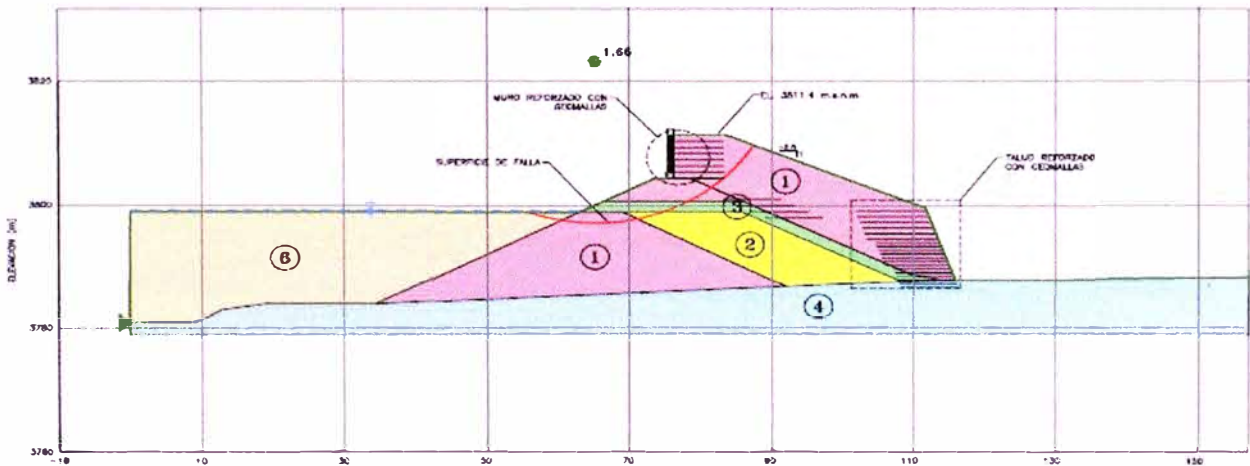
Muro de talud Reforzado - Análisis Estático - Sección B-B
